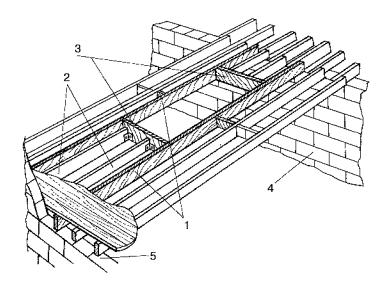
Схема проема в потолочном перекрытии: 1 — продольные деревянные балки; 2 — укороченные балки; 3 — поперечные деревянные балки; 4 — несущая стена постройки; 5 — внутренняя стена или перегородка из кирпича
